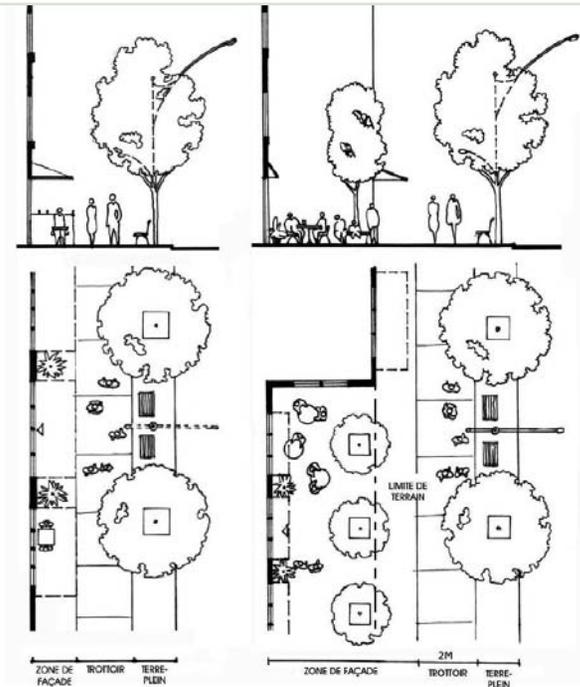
Coupe et plan de paysage de rue illustrant le terre-plein, le trottoir et l'espace pour les équipements de vente au détail (zone de façade).
